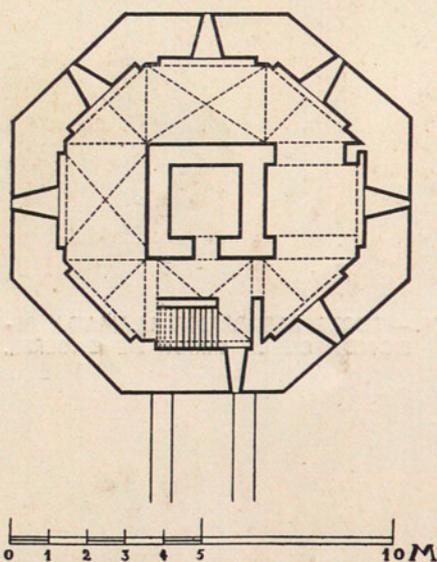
PLANTA SEGUNDA DE LA TORRE DE ESPANTAPERROS, EN LA ALCAZABA DE BADAJOZ.
